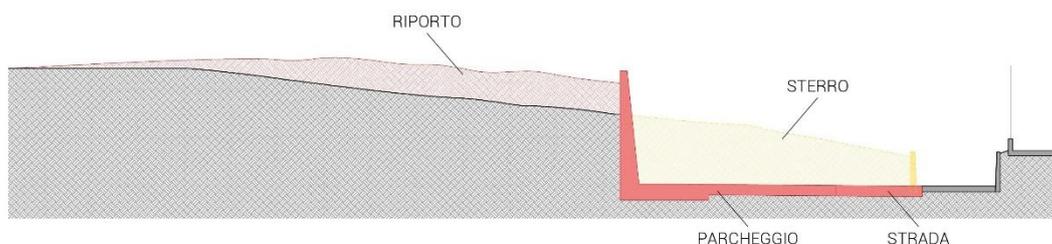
Estratto da All. EA_c_05_R2 Stato di progetto
